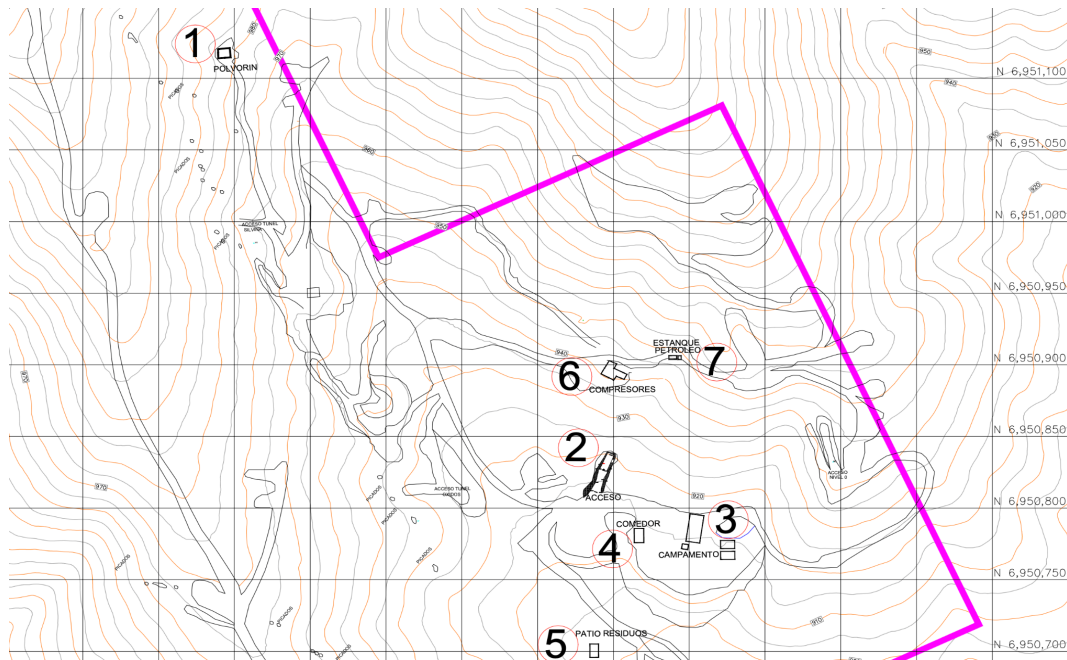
Plano de planta con curvas de nivel SOPLENA
